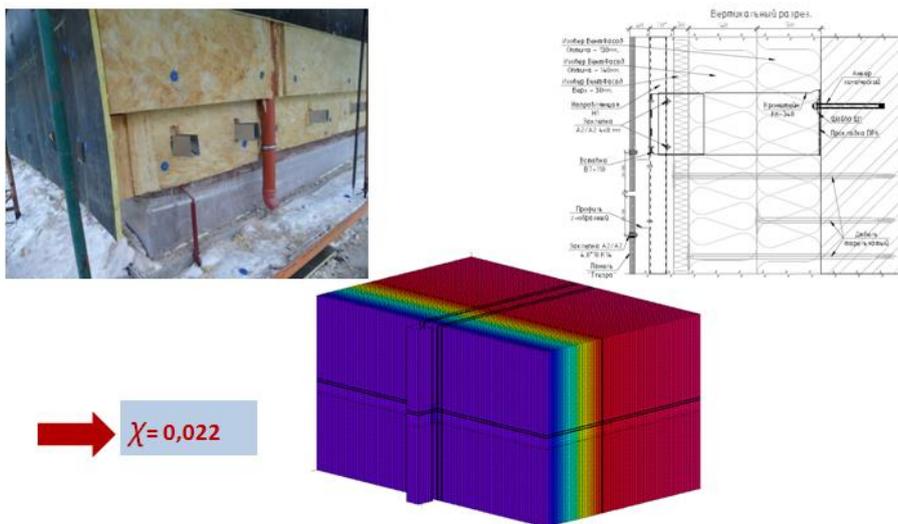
Учет влияния кронштейнов подсистемы вентилируемого фасада.
